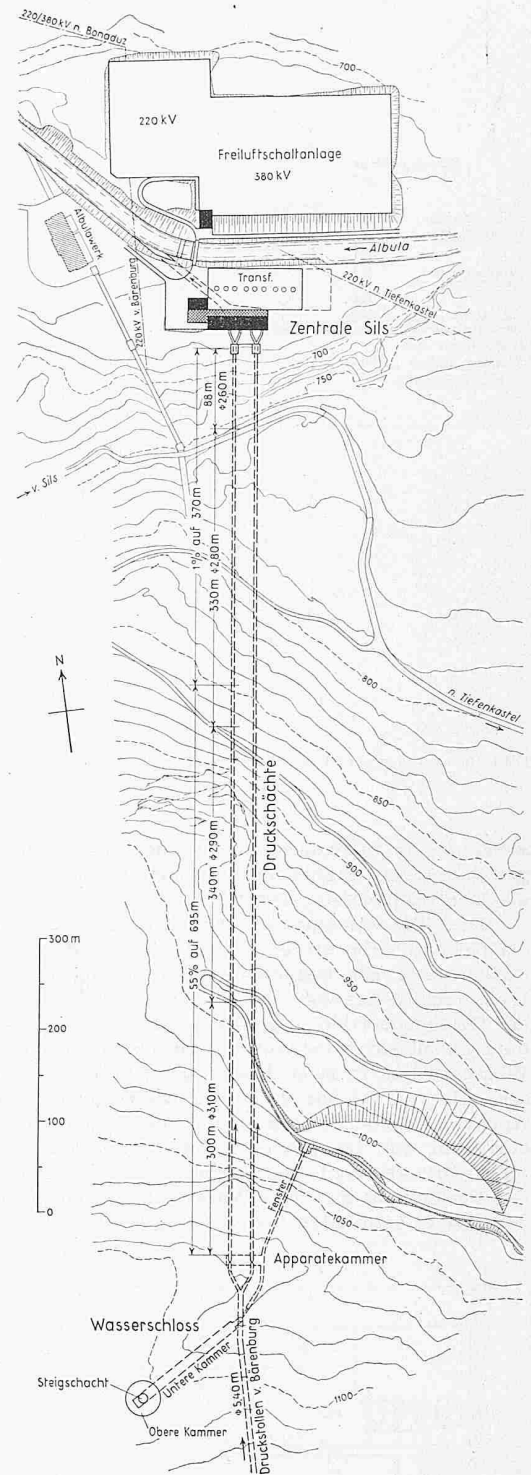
Lageplan des Kraftwerkes Sils, 1:8000
